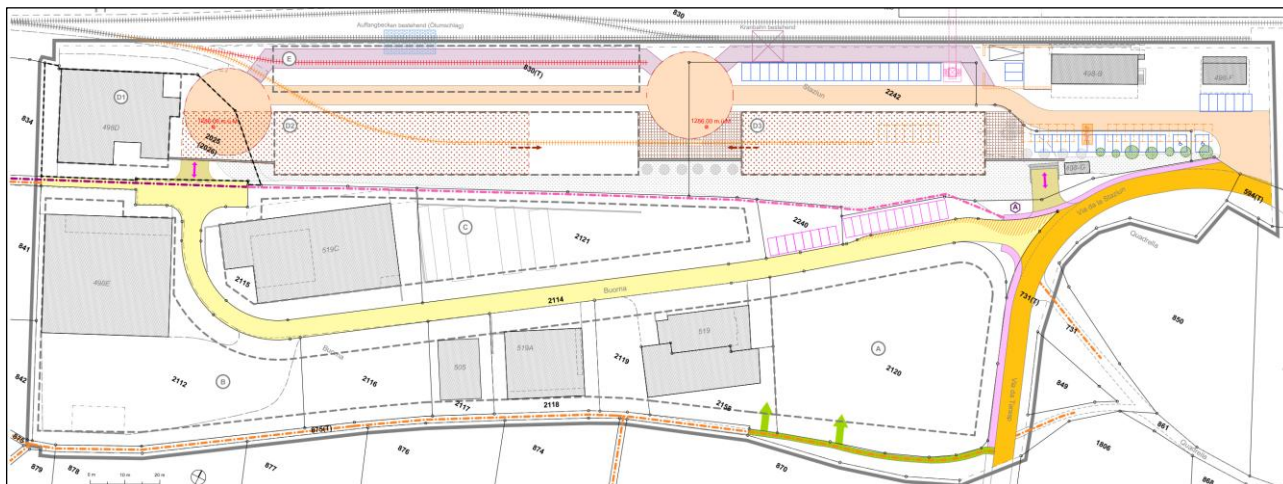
Quartierplan 2026 - Erschliessungsplan Situation
